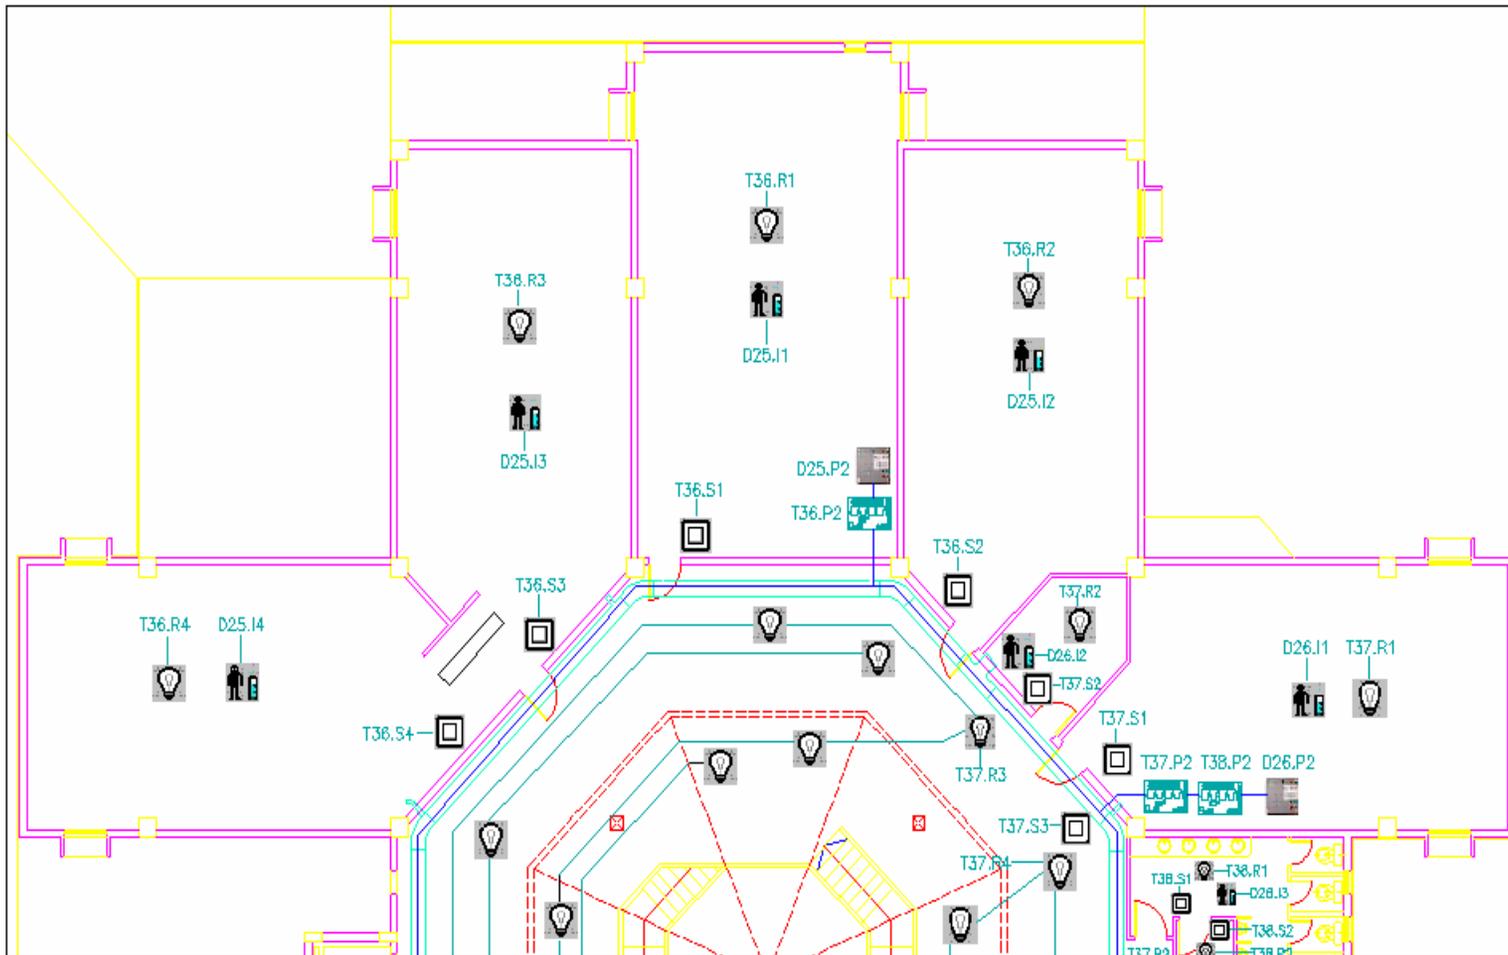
PLANO ILUMINACION SEGUNDO PISO SECCION 2
